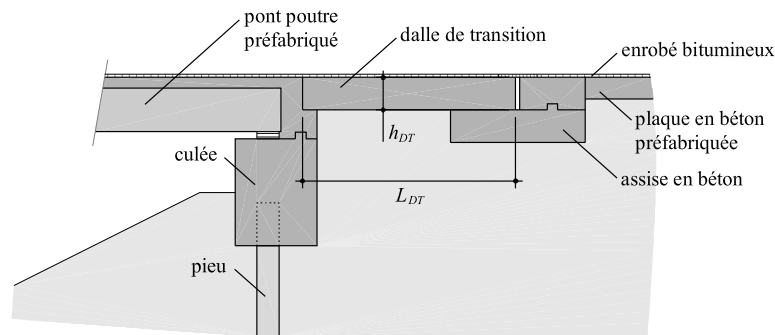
Détail standard d'une dalle de transition d'un pont intégral au New Jersey / USA [New Jersey DOT 2002]
